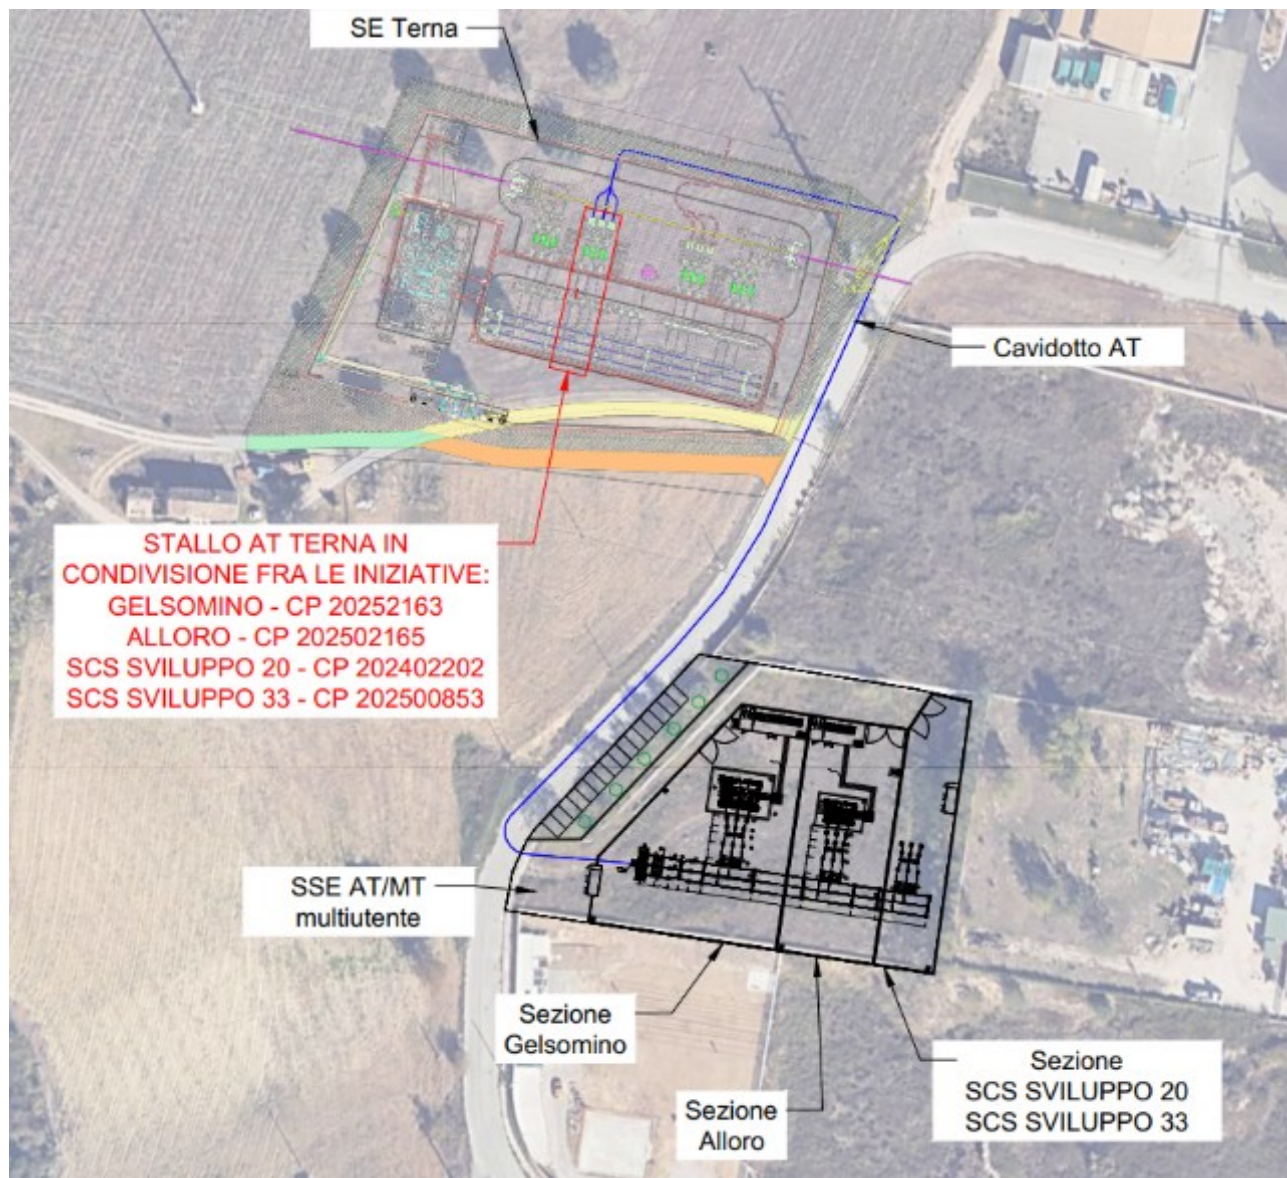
Connessione della SSE multiutente alla Stazione Terna
